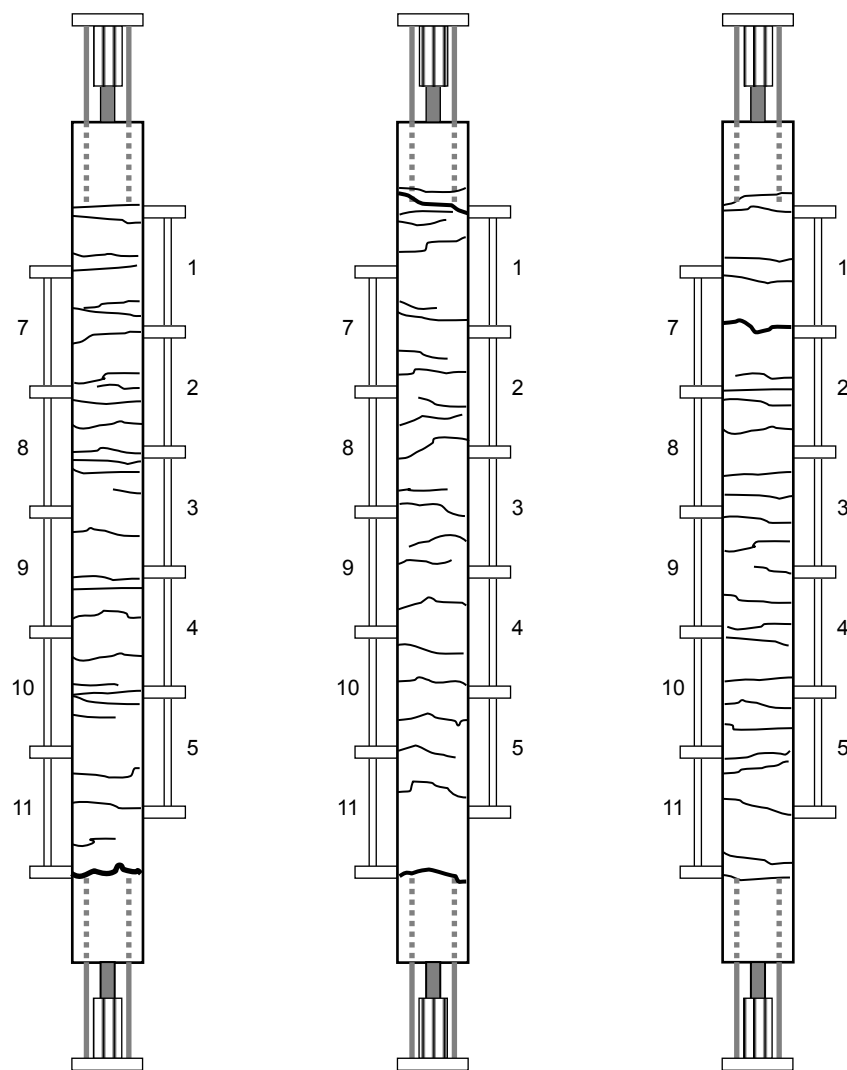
両引き試験体のひび割れ図(TS08-x)
